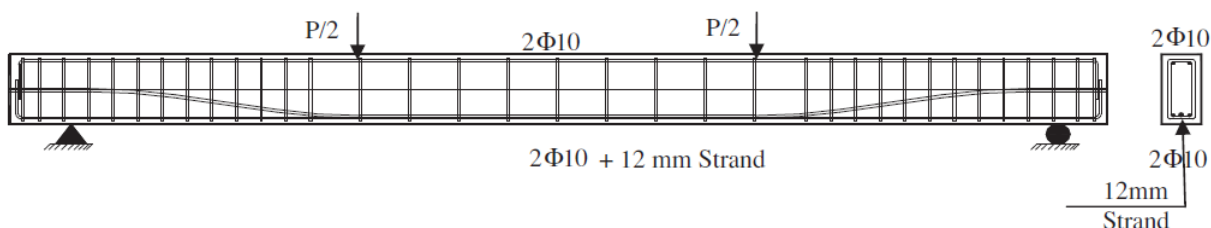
Armaduras para as vigas protendidas B2, B5 e B8
